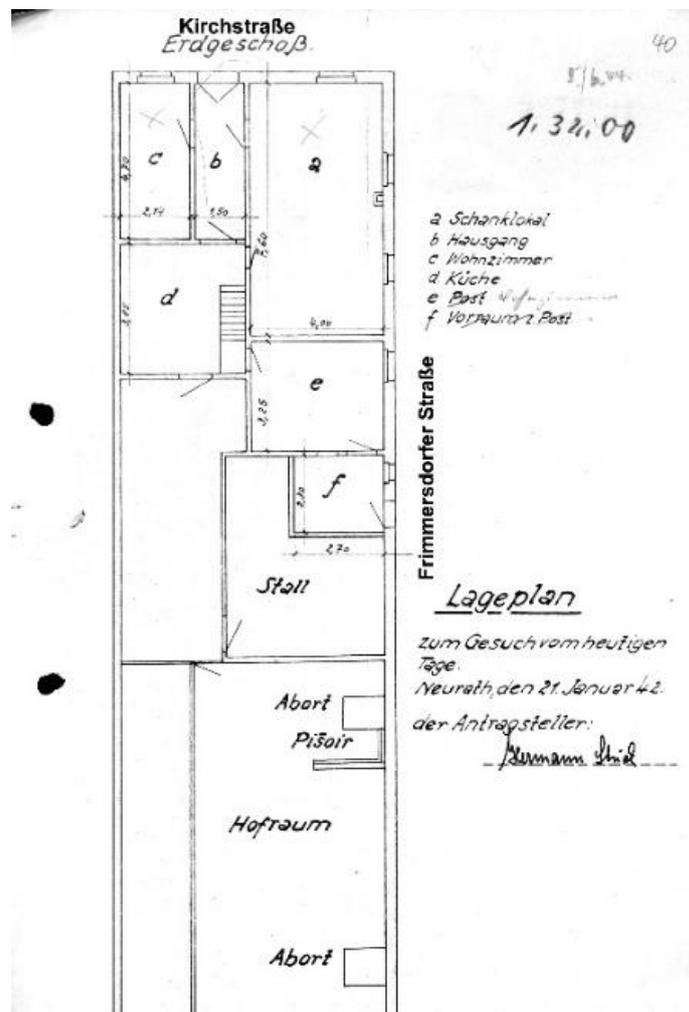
Grundriss der Gaststätte Strick aus dem Antrag vom 21.1.1942 ¹⁸
